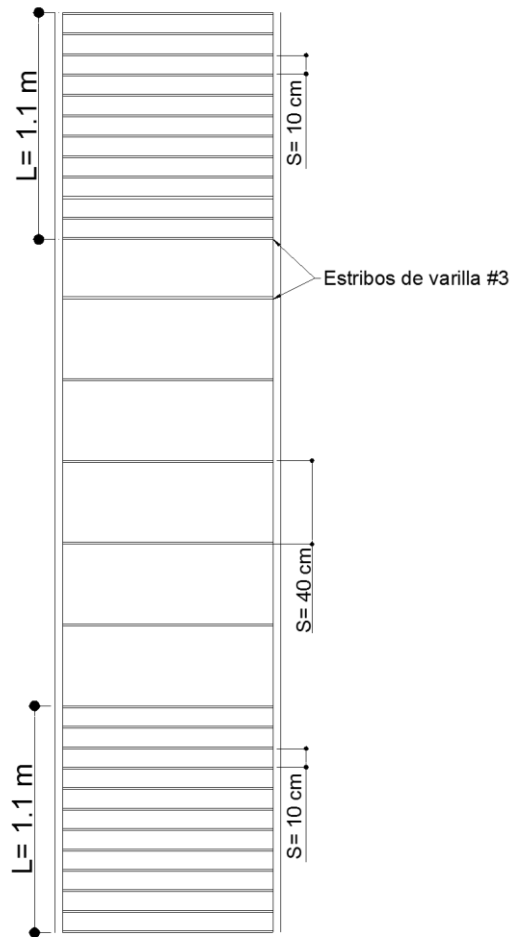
Separación de estribos de columnas cuya sección transversal sea de 1.1 x 1.1 m
